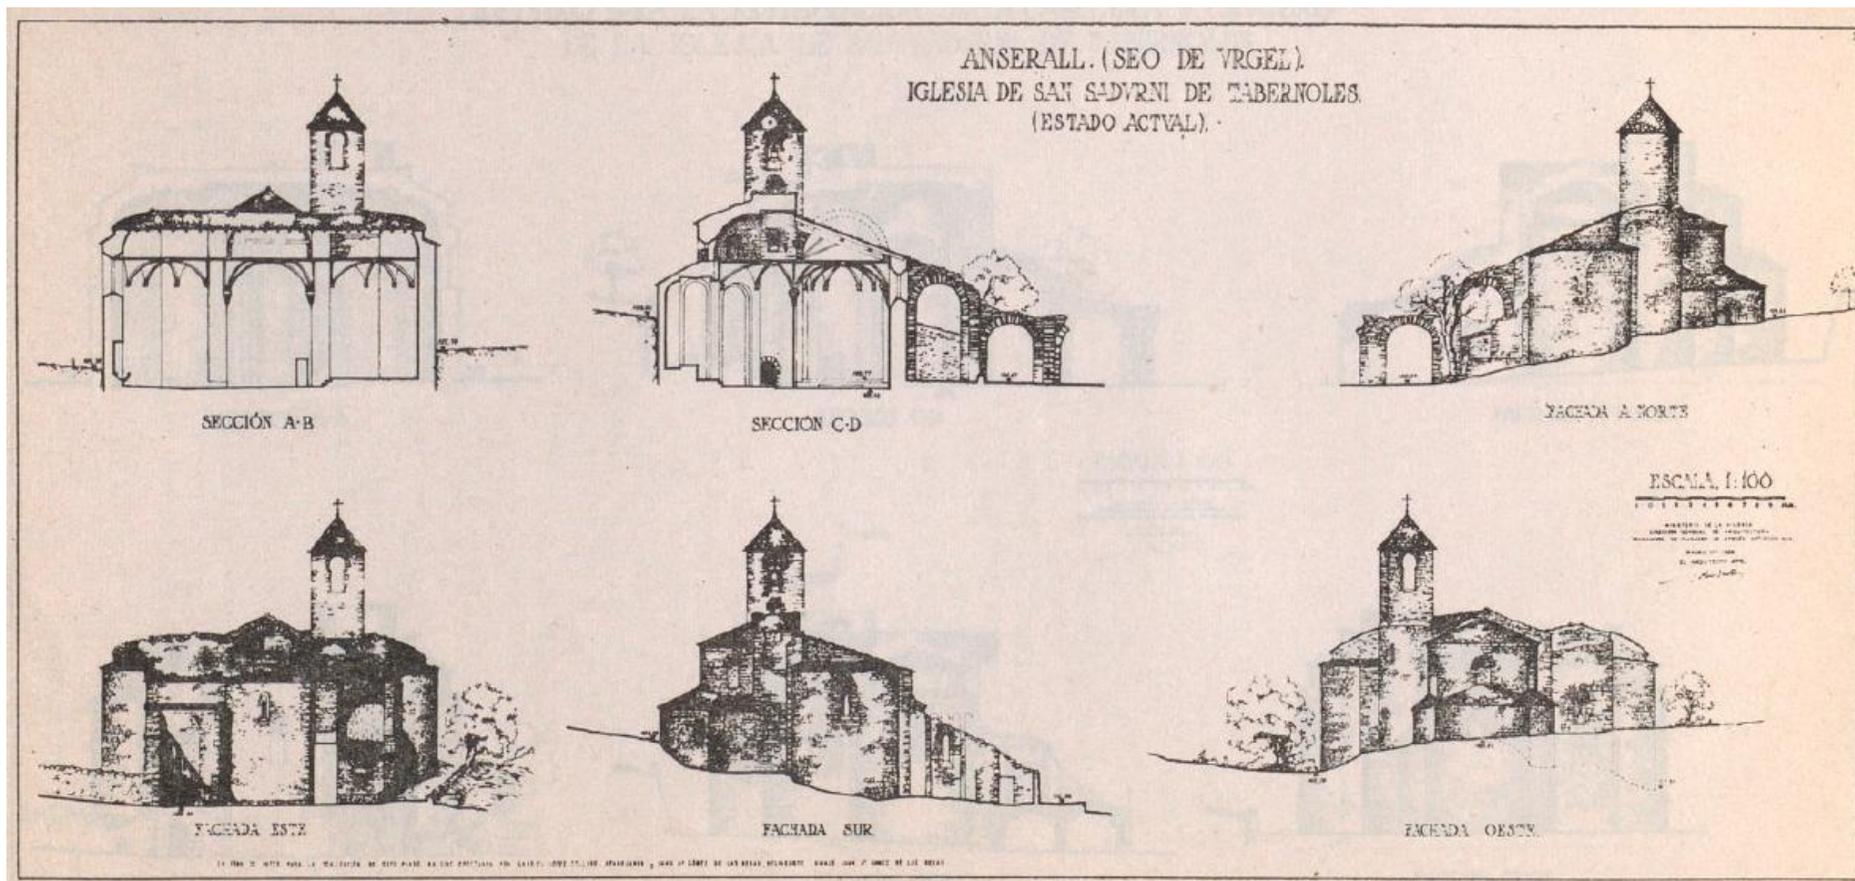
Planos del proyecto de restauración de Pons-Sorolla.
